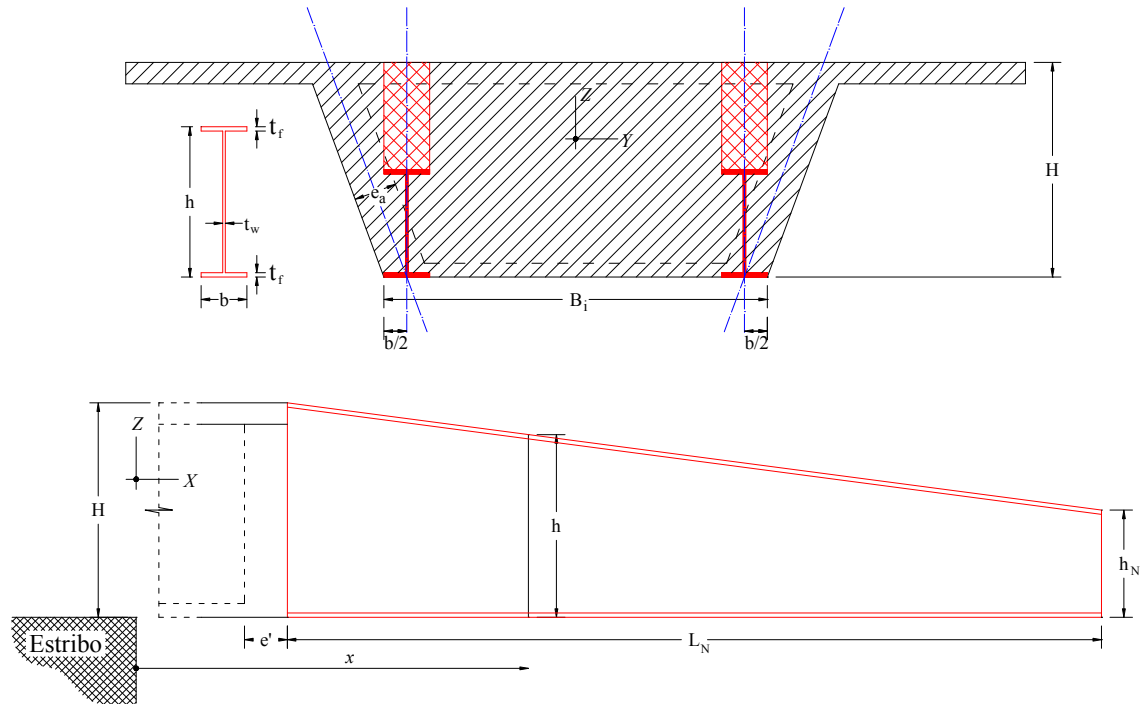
Sección transversal y alzado de un pico de lanzamiento genérico.
